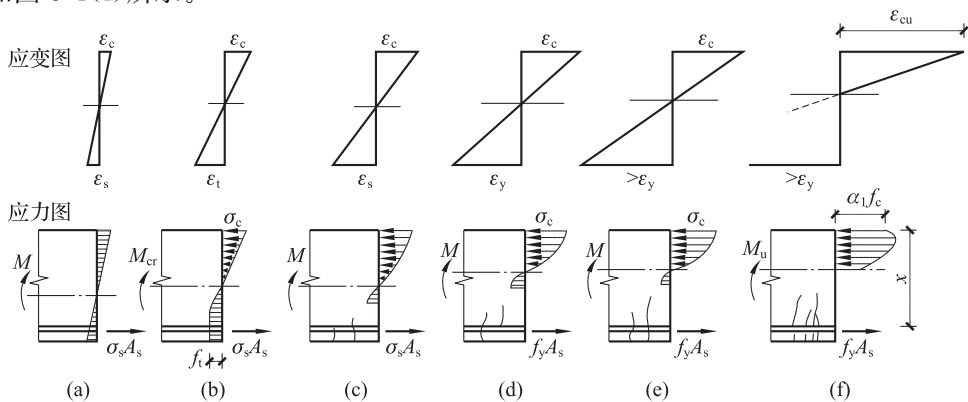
钢筋混凝土受弯构件工作的三个阶段
